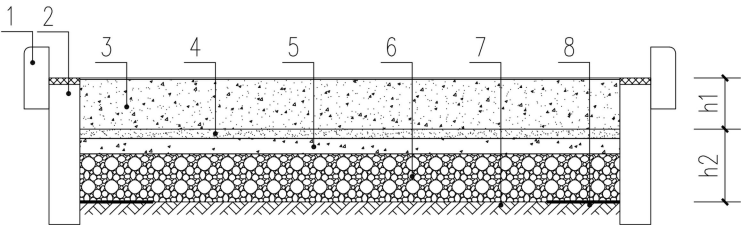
多孔隙透水混凝土（砖）路面排水形式
